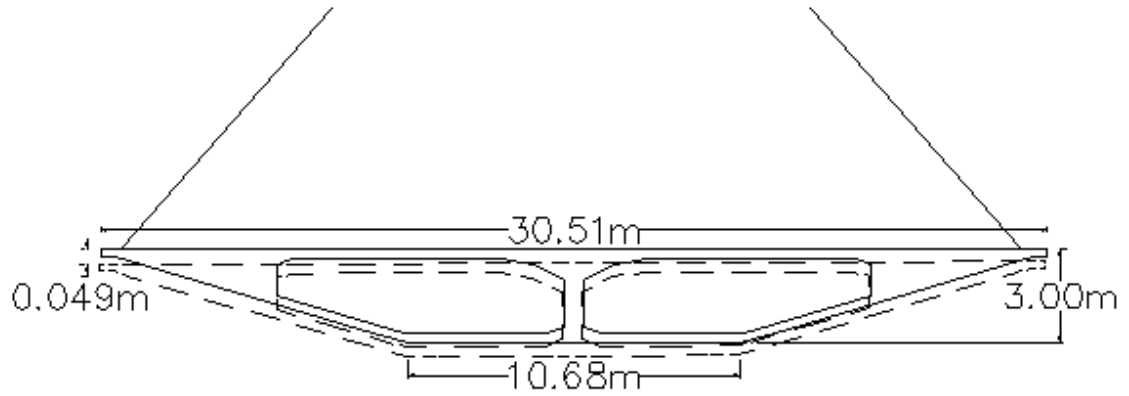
Sección transversal Bicelular-Lateral Deformada. Fuente: Autores
